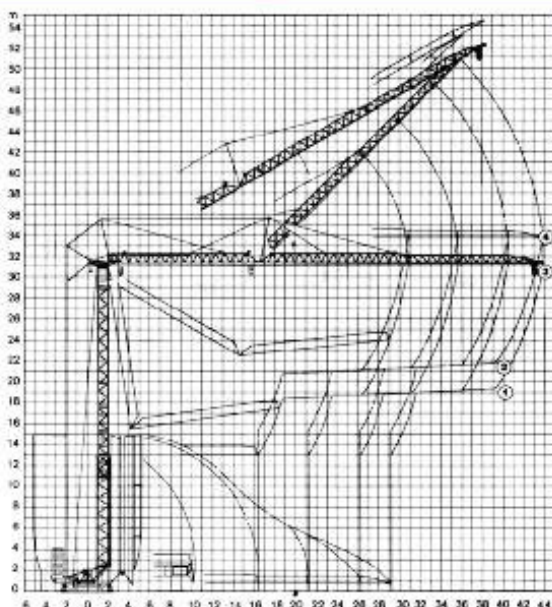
Technický list jeřábu Liebherr 63 K [5]
